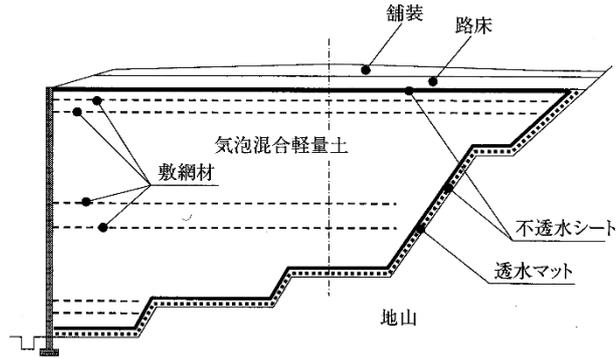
不透水シート、敷網材の施工例⁸⁾
